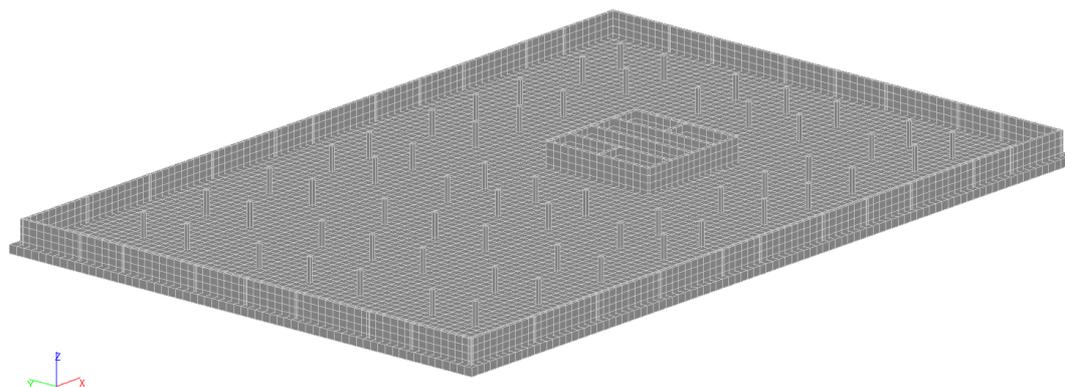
Конечно элементная схема фундаментной плиты
